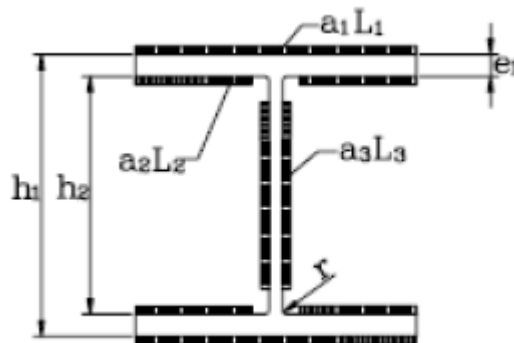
44. Predimensionamiento de los cordones de soldadura.
